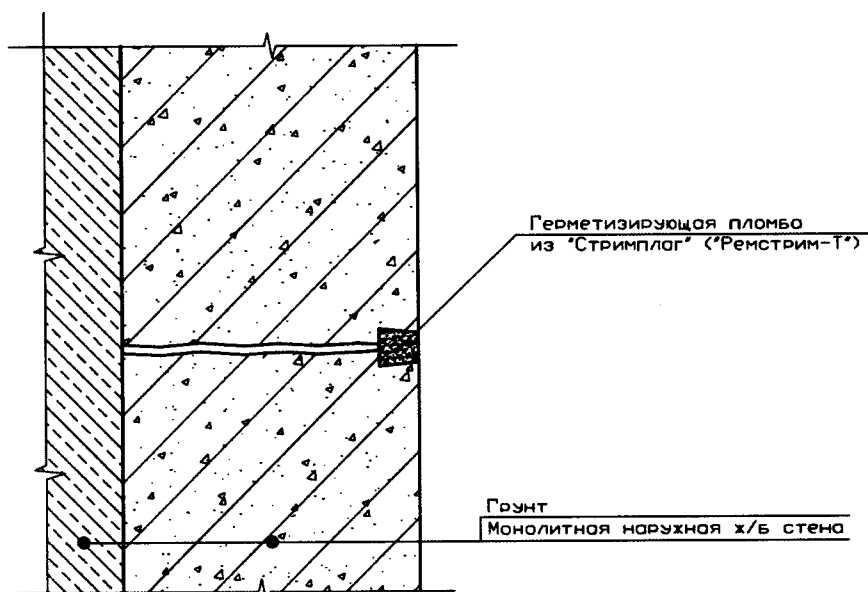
Герметизация технологических швов бетонирования, трещин (вид сверху). Устройство герметизирующей пломбы
